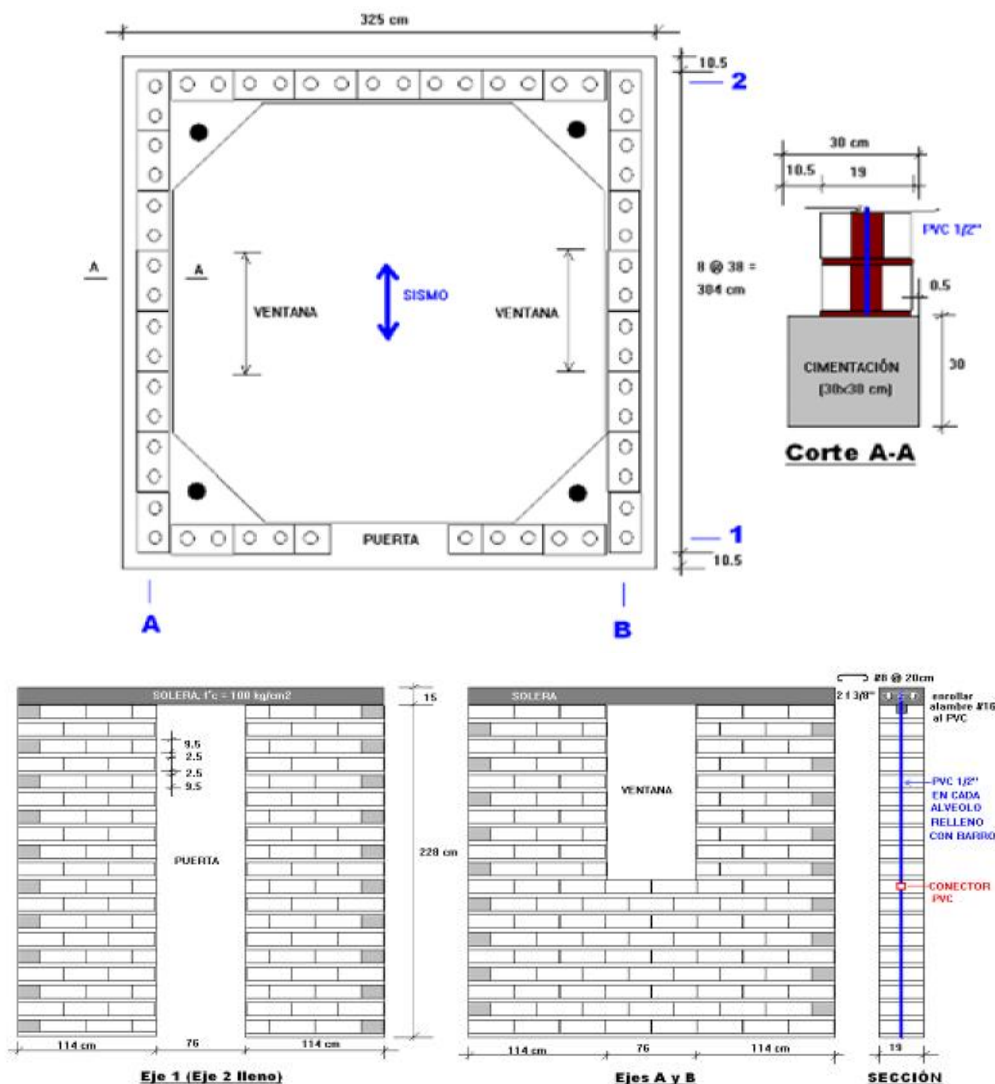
Características del muro reforzado M2 (el muro M1 careció de tubos PVC). Medidas en centímetros.
